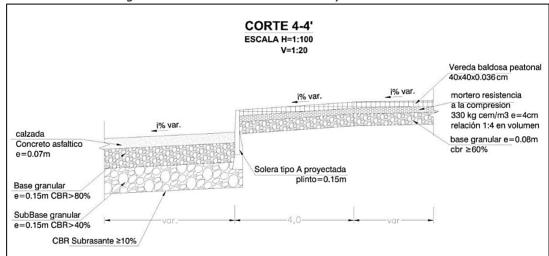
Detalle Corte Pavimento y Vereda Baldosa
